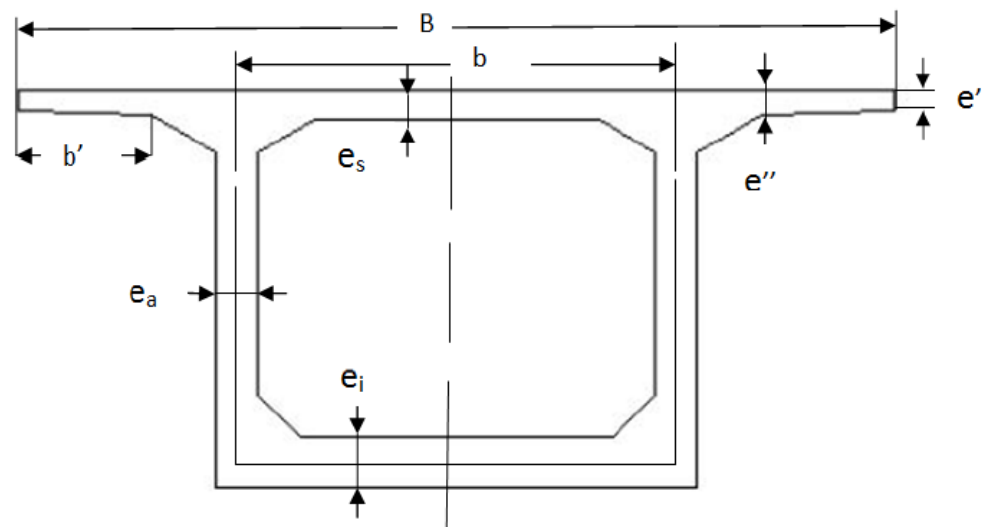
Coupe transversale d'un caisson simple à deux âmes.
